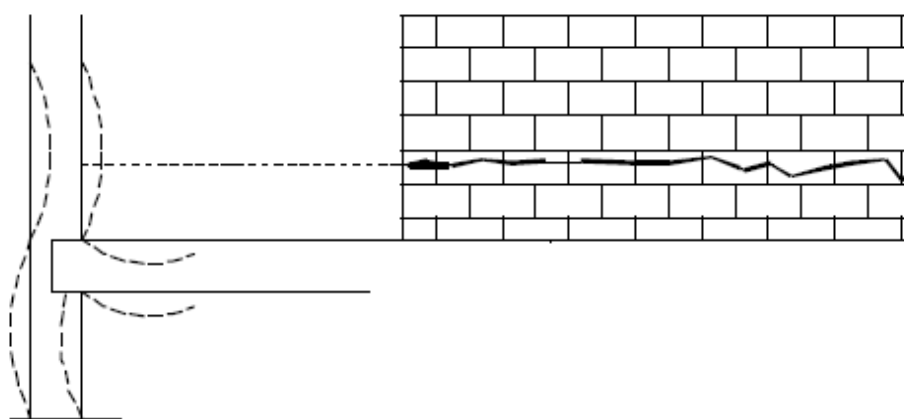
Fissuração Horizontal oriunda da expansão das lajes
